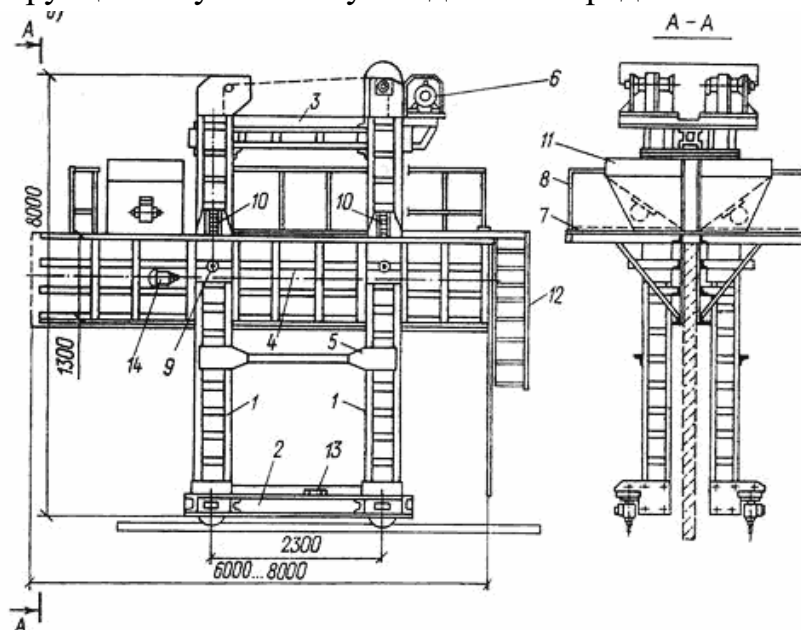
Устройство скользящей опалубки: 1 – стойка; 2 – тележка; 3 – балка; 4 – щит опалубки; 5 – монтажное устройство; 6 – лебедка подъема щитов; 7 – настил; 8 – ограждение; 9 – ползуны; 10 – фиксаторы; 11 – бункер; 12 – лестница; 13 – электрический привод; 14 – поверхностный вибратор
